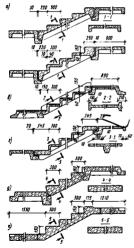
Конструктивные решения железобетонных полносборных лестинц:
